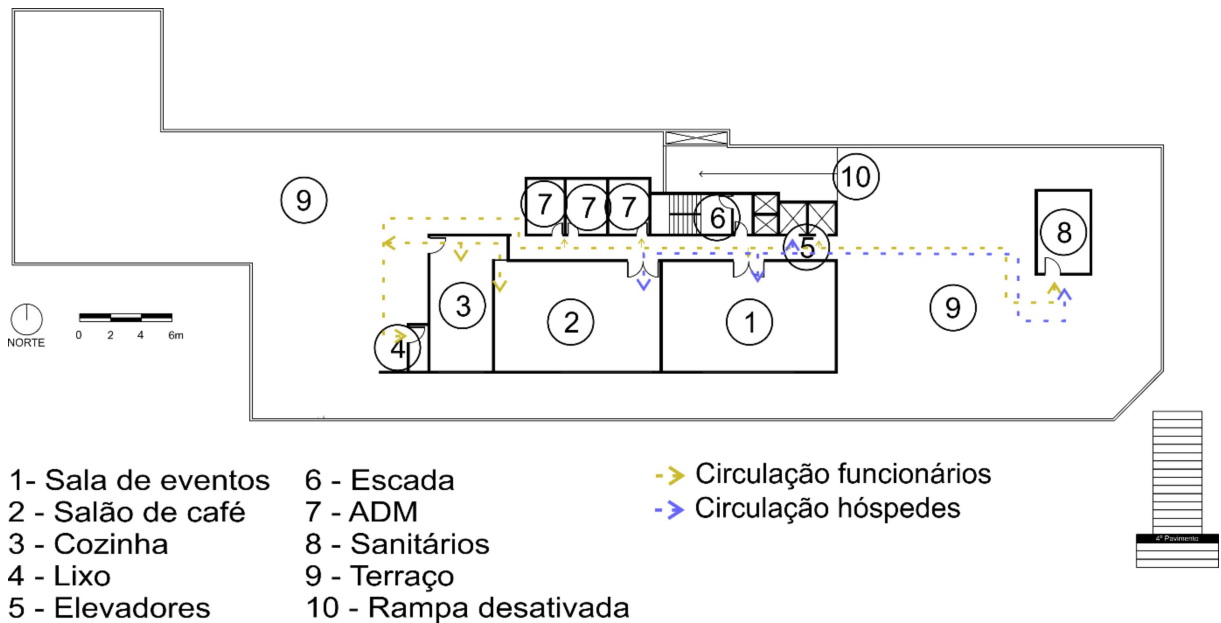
Planta Baixa Pavimento térreo hotel B.
